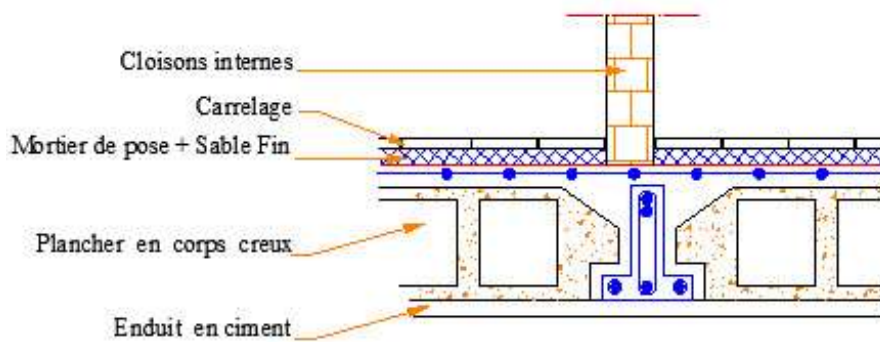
Coupe verticale du plancher étages courants (corps creux)
